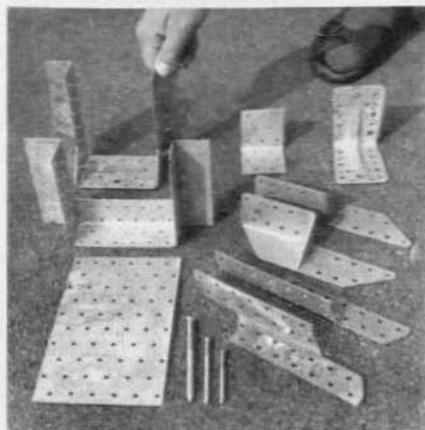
Verzinkte Holzverbinder: mit Nägeln zu befestigende Lochplatten (HVV-Verbinder)
